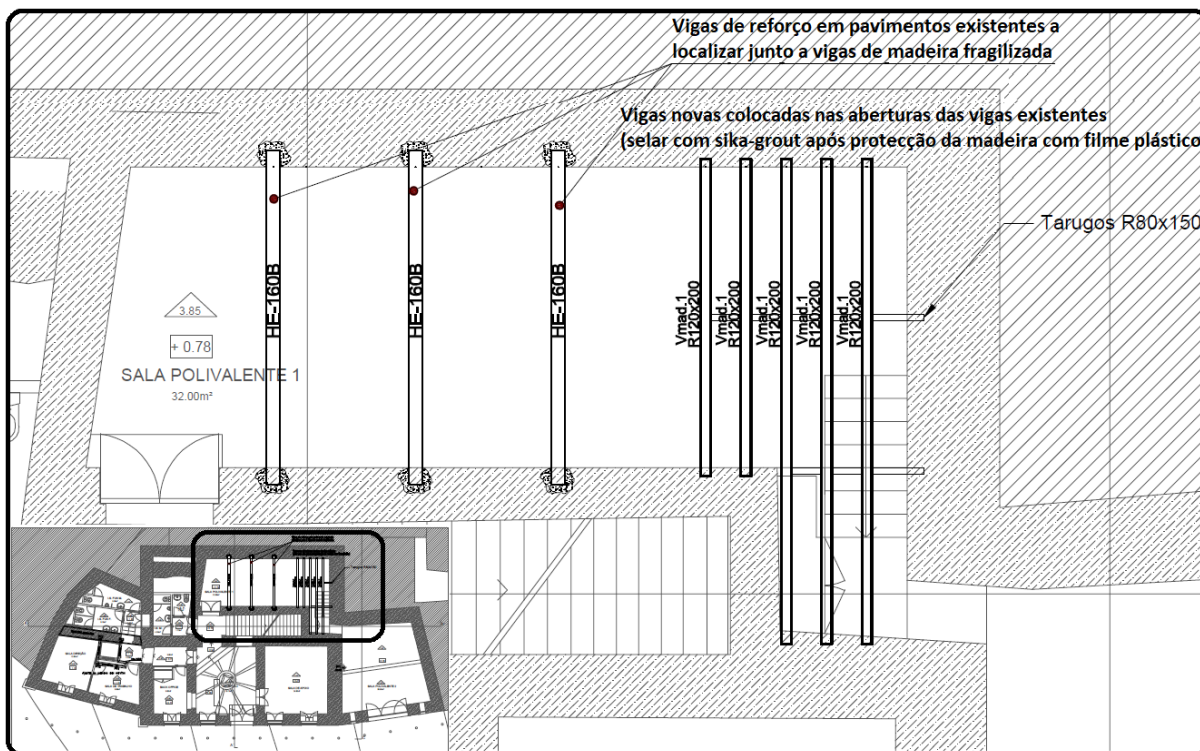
Pormenor do reforço dos pavimentos existentes (planta)
